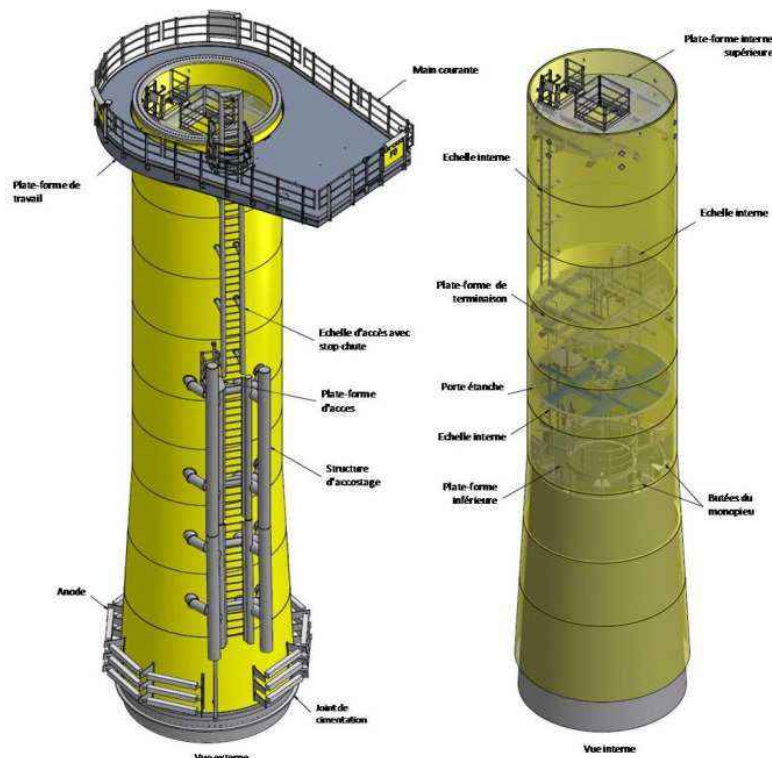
Structures secondaires d'une pièce de transition – Walney (source DONG energy)
